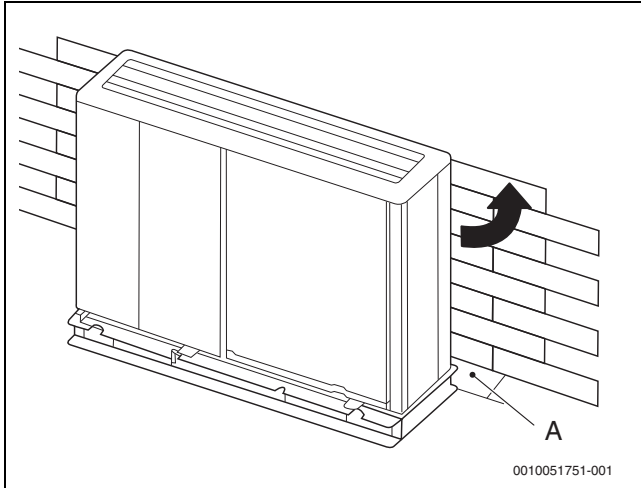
Ochrana jednotky před mimořádně silným větrem
